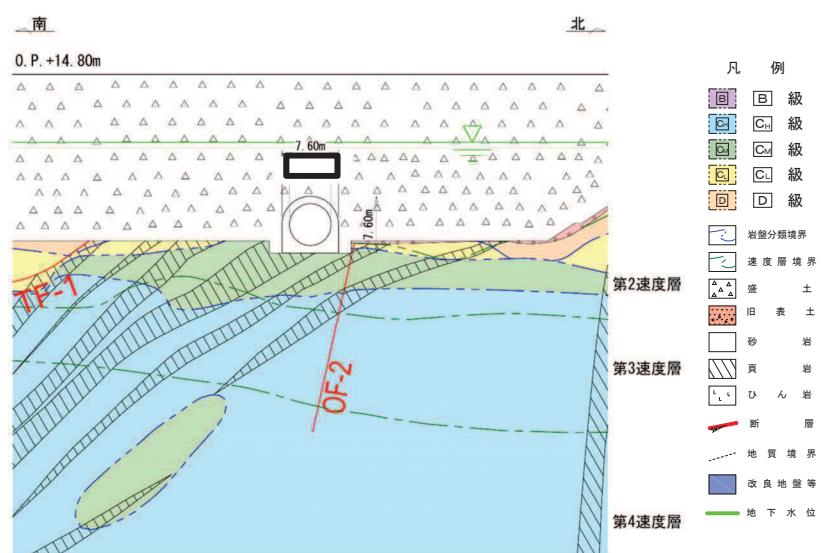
排気筒連絡ダクト（土砂部）地質断面図（A-A 断面）
